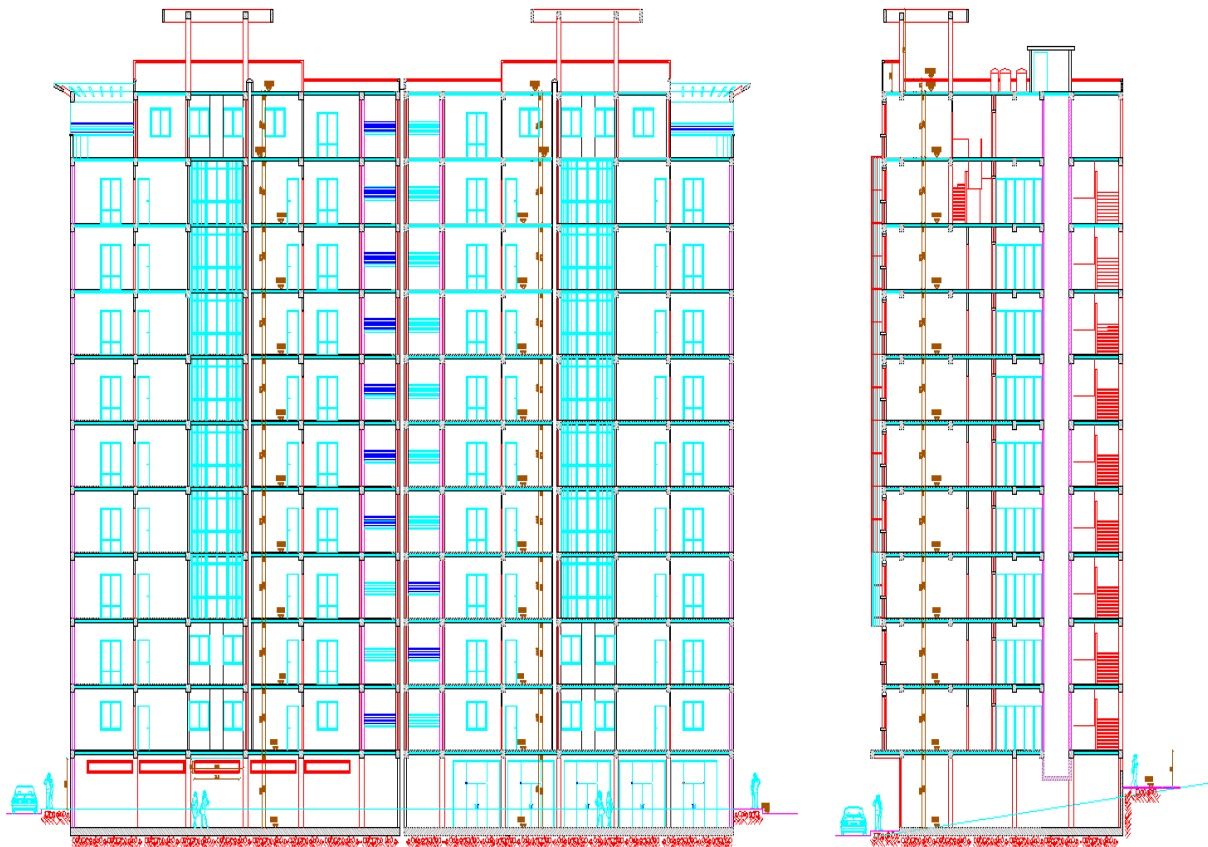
Coupe A-A et coupe B-B ech :1/50
